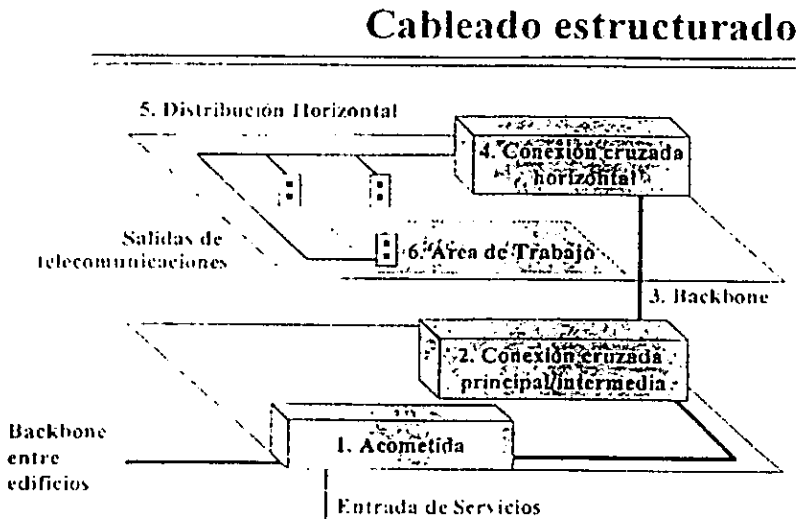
Subsistemas del cableado estructurado^{xxxx}
